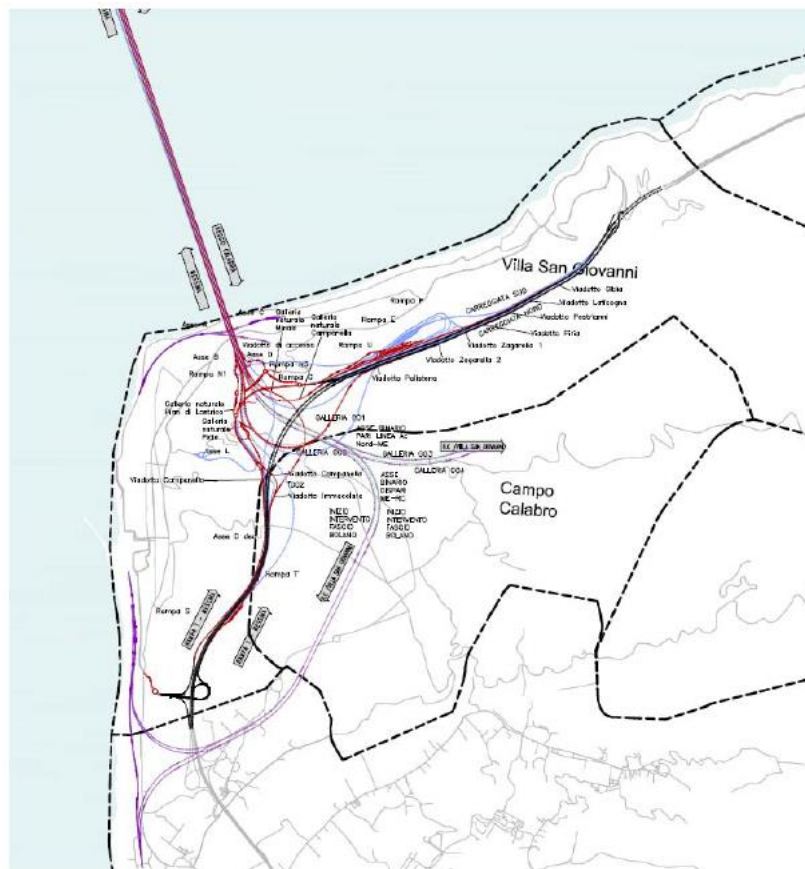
Lato Calabria –Sovrapposizione tracciati PP (azzurro) PD (rosso e viola)
